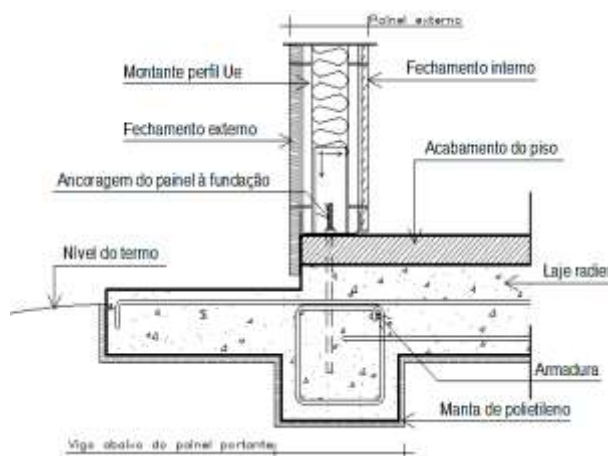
Detalhe esquemático de ancoragem de painel estrutural à uma laje radier.
